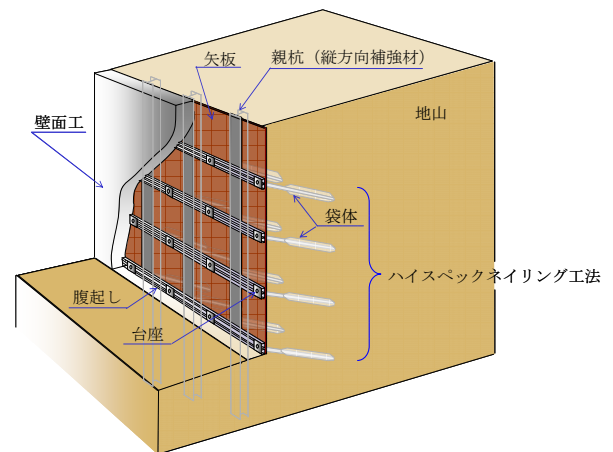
ハイスpekクネイリング工法を用いた土留め工 Earth Retaining Wall with New Soil Nailing Method
